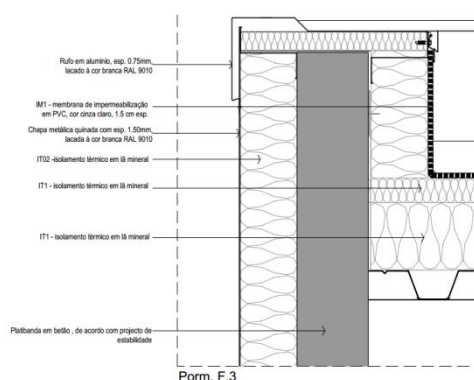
Pormenor de impermeabilização da Fachada - Coroamento da Platibanda (h < 0.50 m) [Fonte: CPU/BDP Ref. 201.2.02]
